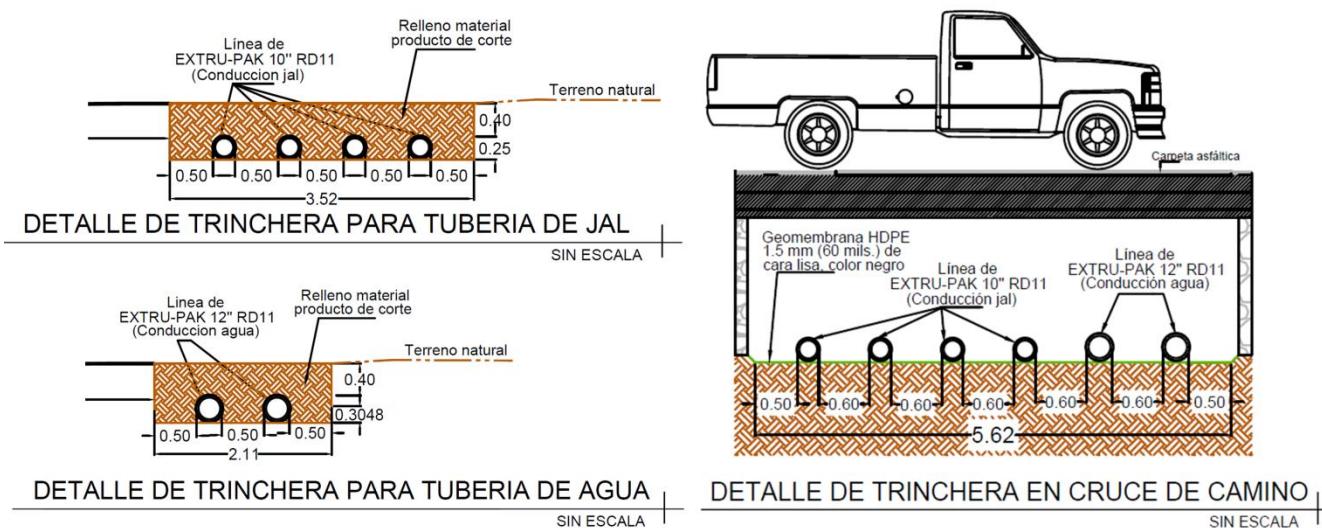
Detalle de las trincheras para tuberías de conducción de jales y agua clarificada
